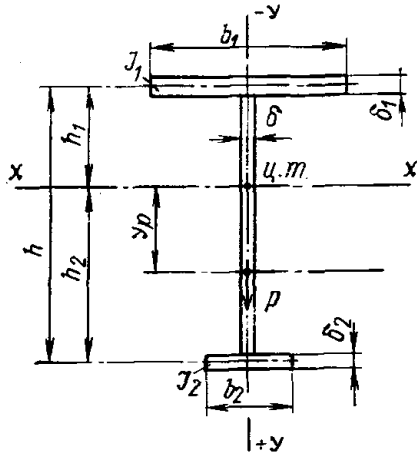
Поперечное сечение балки с развитым верхним поясом
